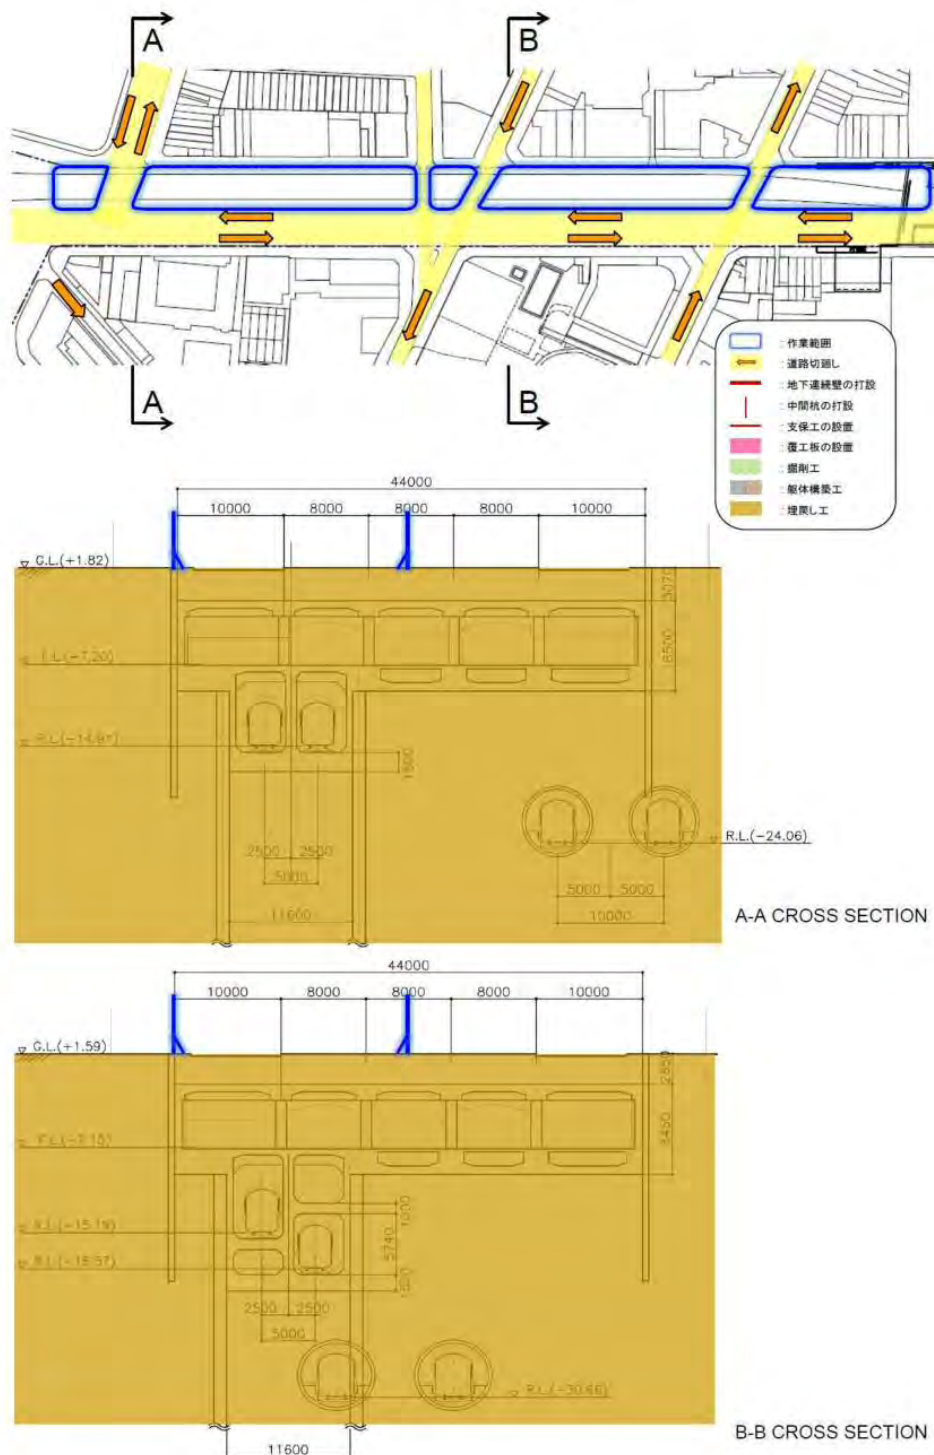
レロイ通り地区の都市鉄道1号線と地下街の施工手順図 (その2/14)
